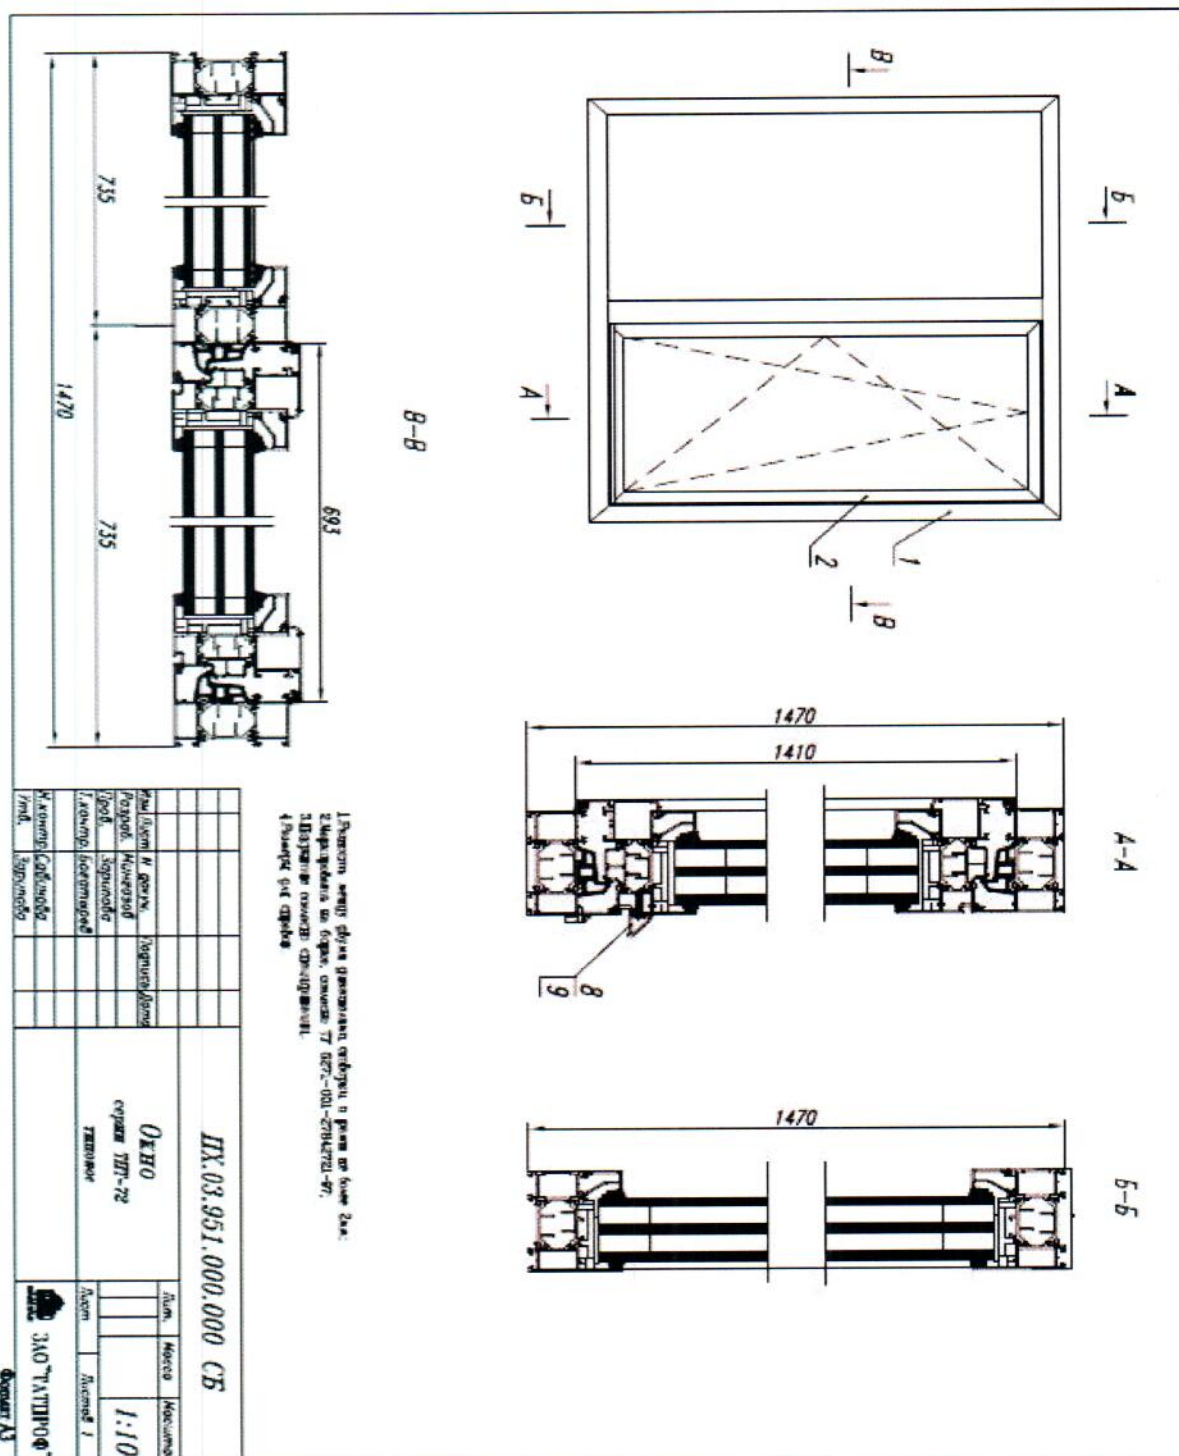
Чертеж блока оконного из профилей алюминиевых сплавов ТПТ-72 с двухкамерными стеклопакетами СПД 83И - 12Ar - 63 - 12Ar - И63
